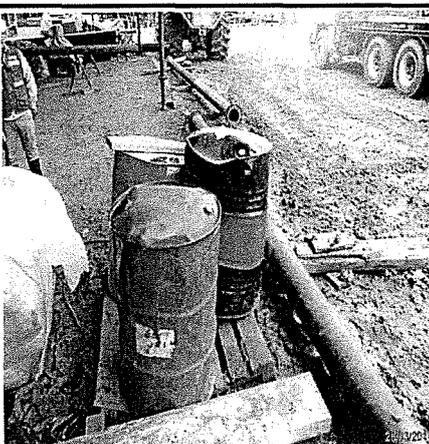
E0373699 N9723602/ Área de Construcciones.
